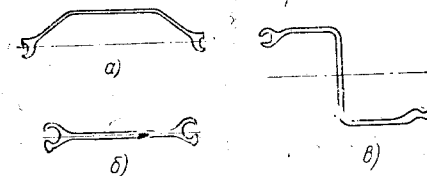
Профили шпунтовой стали: а — корытная; б — плоская; в — зетовая
